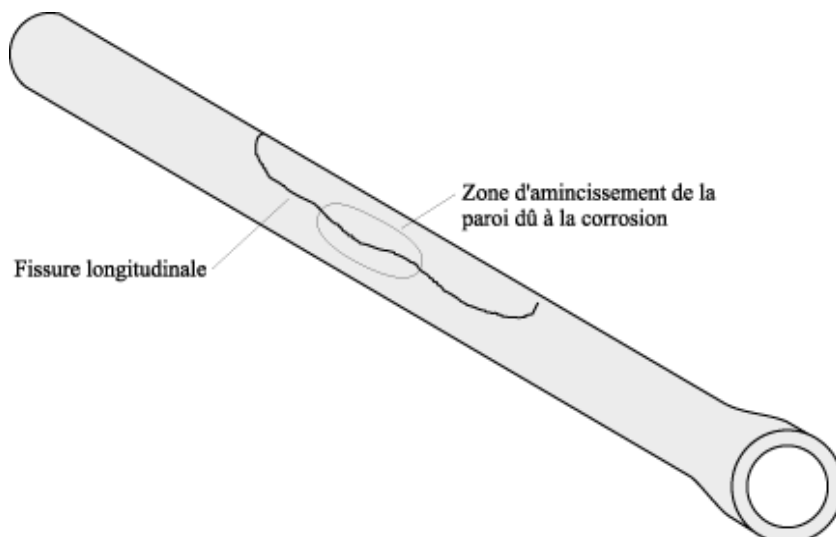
Différents types de ruptures des conduites d'eau potable (Fissure longitudinale)
